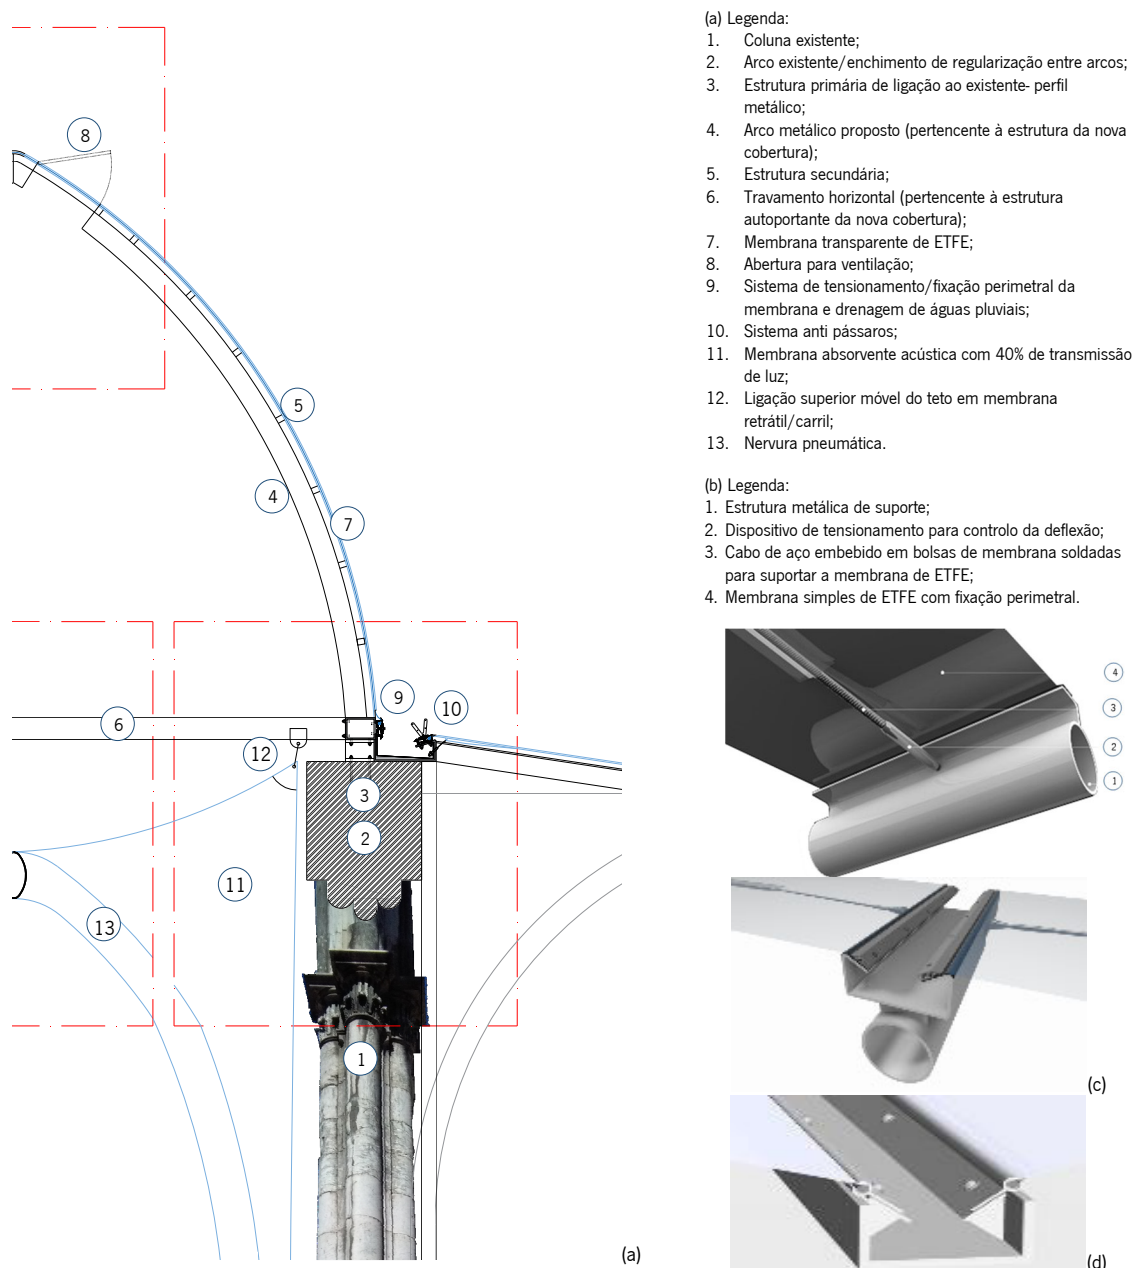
(a) Pormenor de ligação da solução em membrana ao existente. Tipos de ligações/ modos de tensionamento/ reforço da membrana de ETFE: (b) reforço da membrana simples de ETFE com cabos embestados em bolsas de ETFE (Birdair, 2018); (c) (d) com canal de drenagem.
